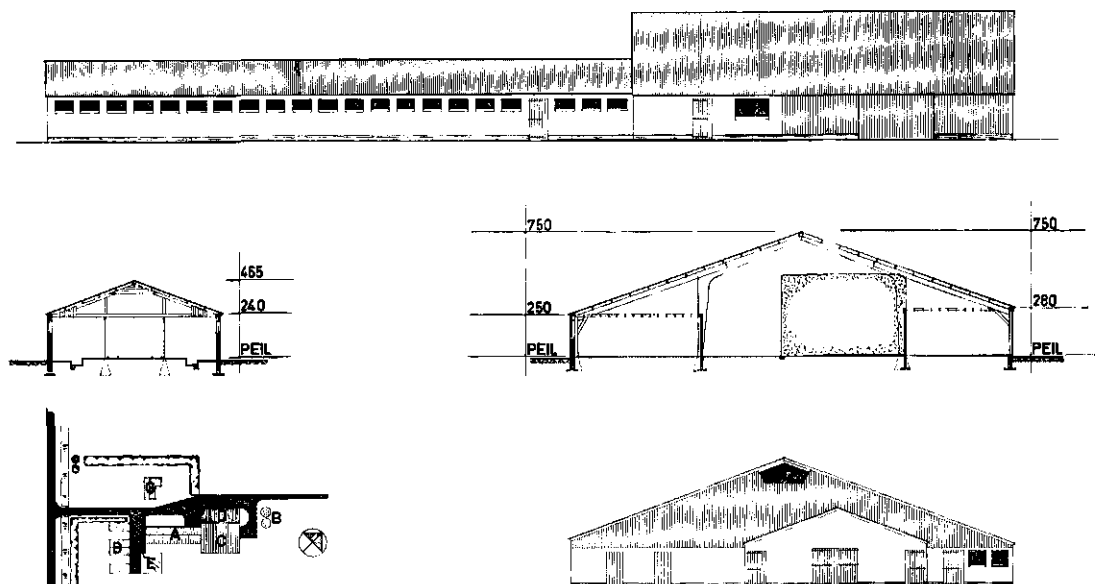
Plan I: gevels, doorsnede, erfindeling
